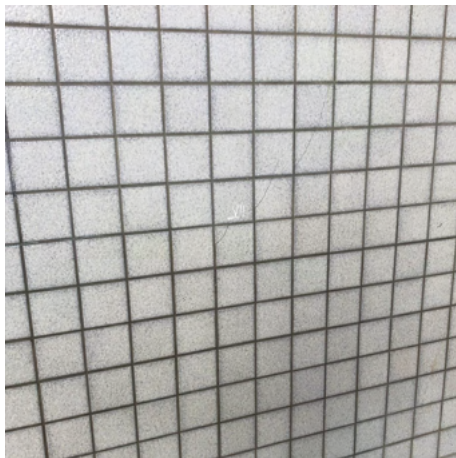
Fissura V5 (14/07/2021)
